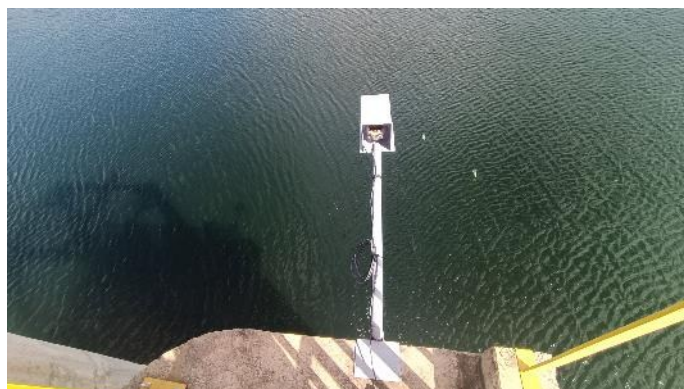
Barragem Boa Vista –Torre da TUD
